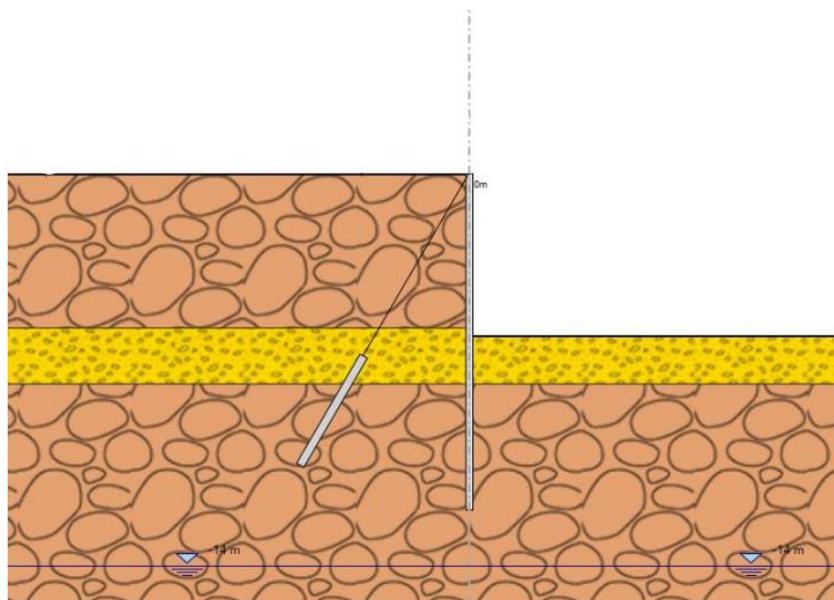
Sezione tipologica di progetto delle opere provvisorie
